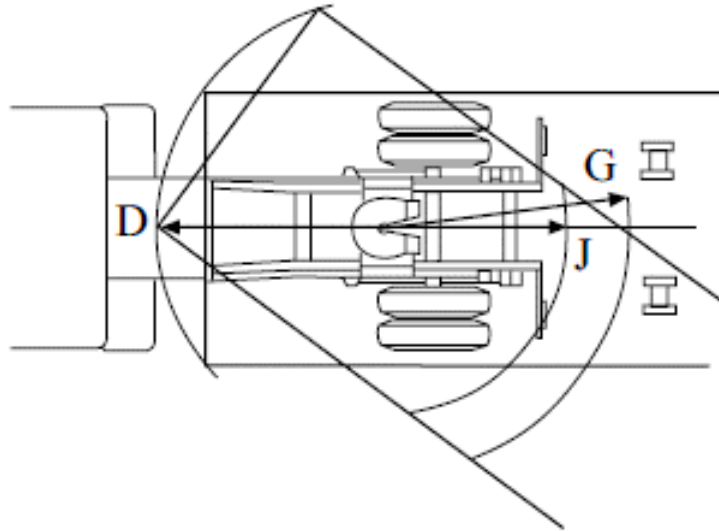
Dimensiones necesarias para maniobrar el tracto camión.
